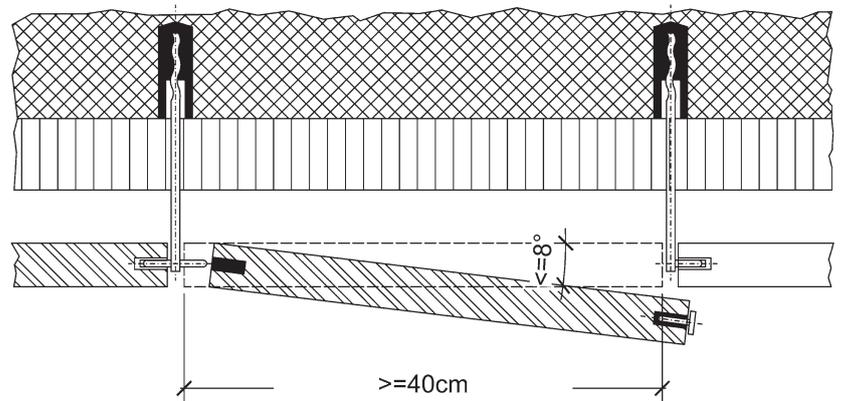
Austausch einer Fassadenplatte mit Anker in der vertikalen Fuge.
